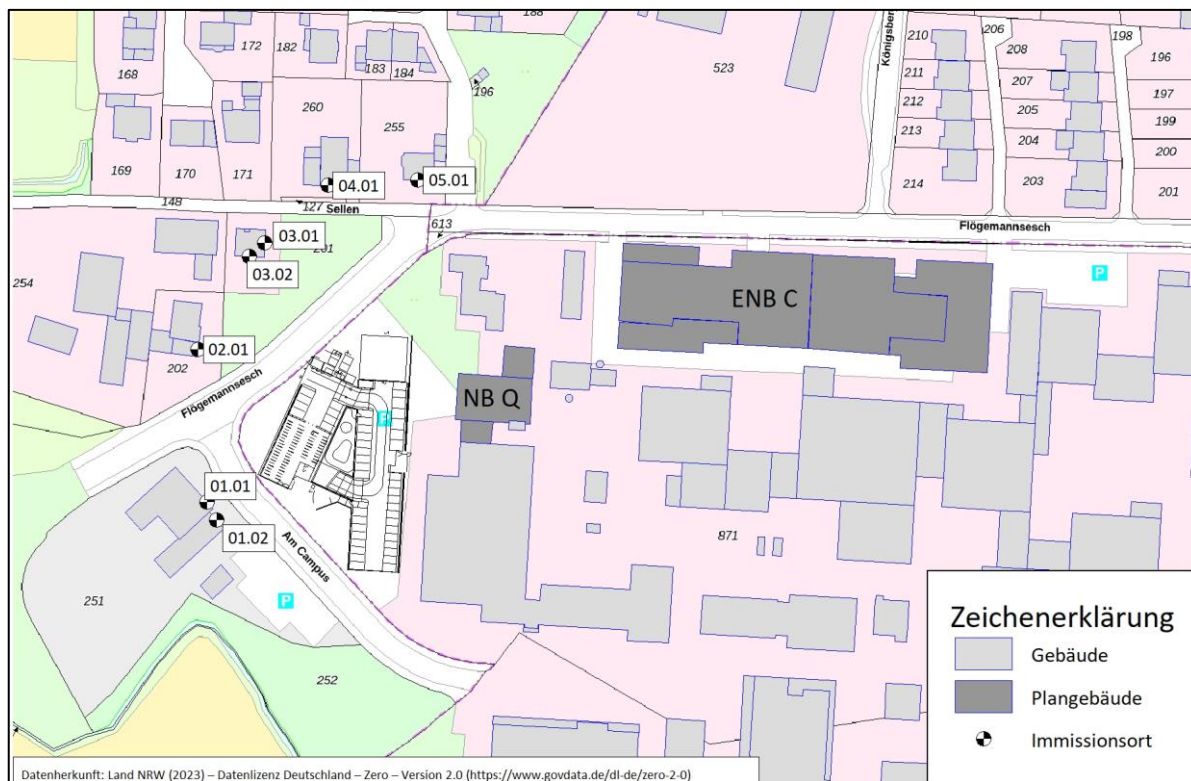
Übersichtslageplan mit Darstellung der betrachteten Immissionsorte
